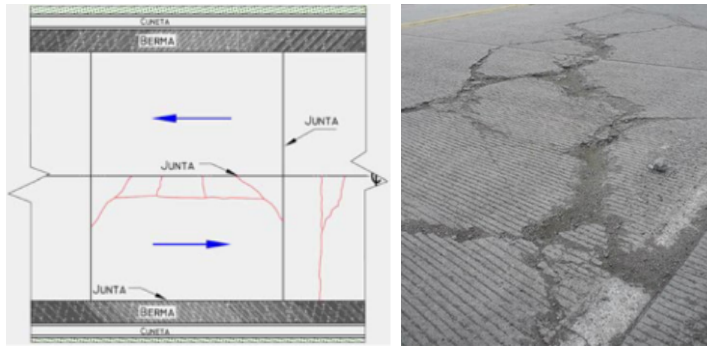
Características de las grietas en bloque y las grietas tipo “Y” (INVIAS, 2006)
